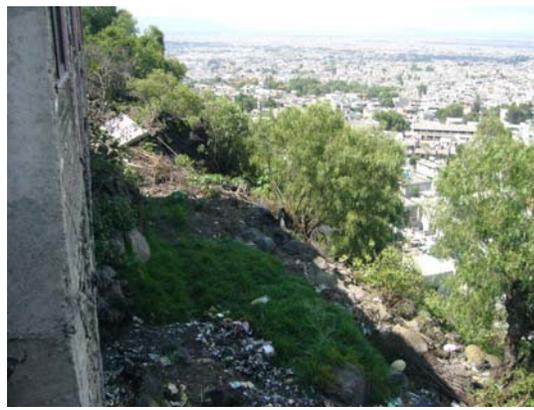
Muro de contención construido a lo largo de la calle Jarrito.
